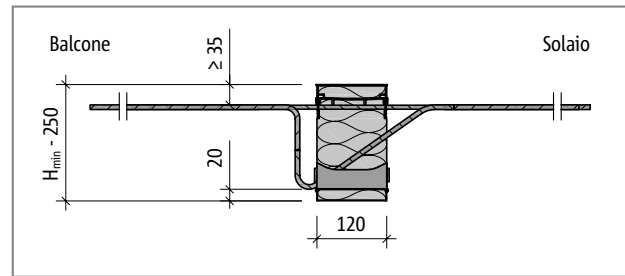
Schöck Isokorb® tipo KXT45, KXT50: sezione dell'elemento
